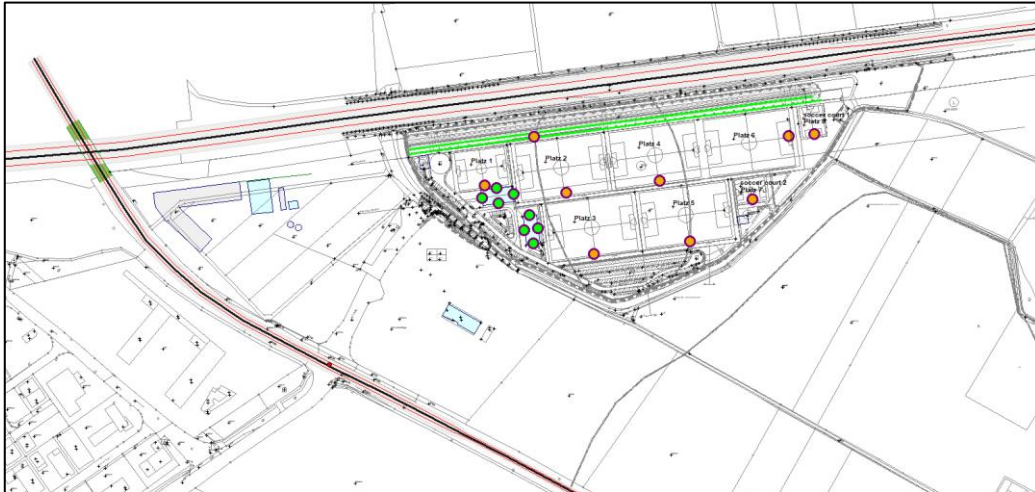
Lageplan Verkehrsanlagen A3 und B 8
